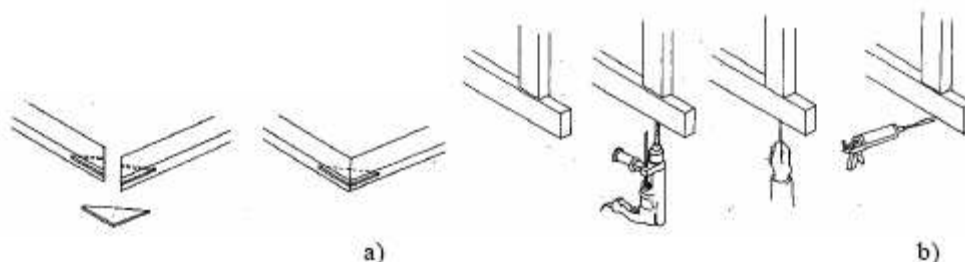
Reforço de ligações com elementos de madeira, execução do reforço de ligações de topo (ROTAFIX, 2007)
